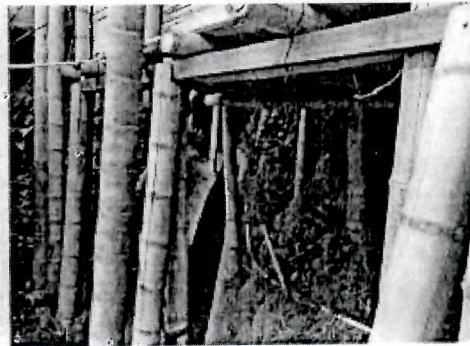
Apoyo vivienda recamara, presenta filtraciones.
